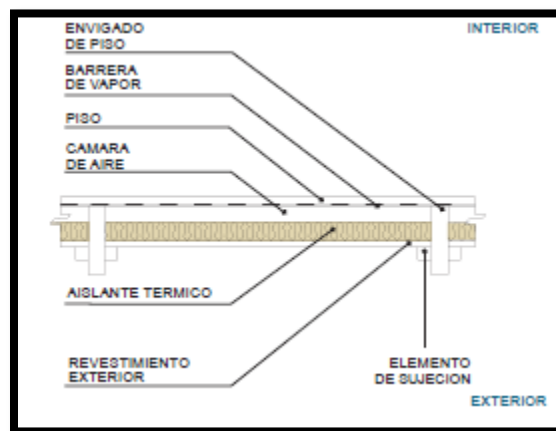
Piso con vigas ventilado. Barrera de vapor por el interior y aislante térmico por el exterior.
